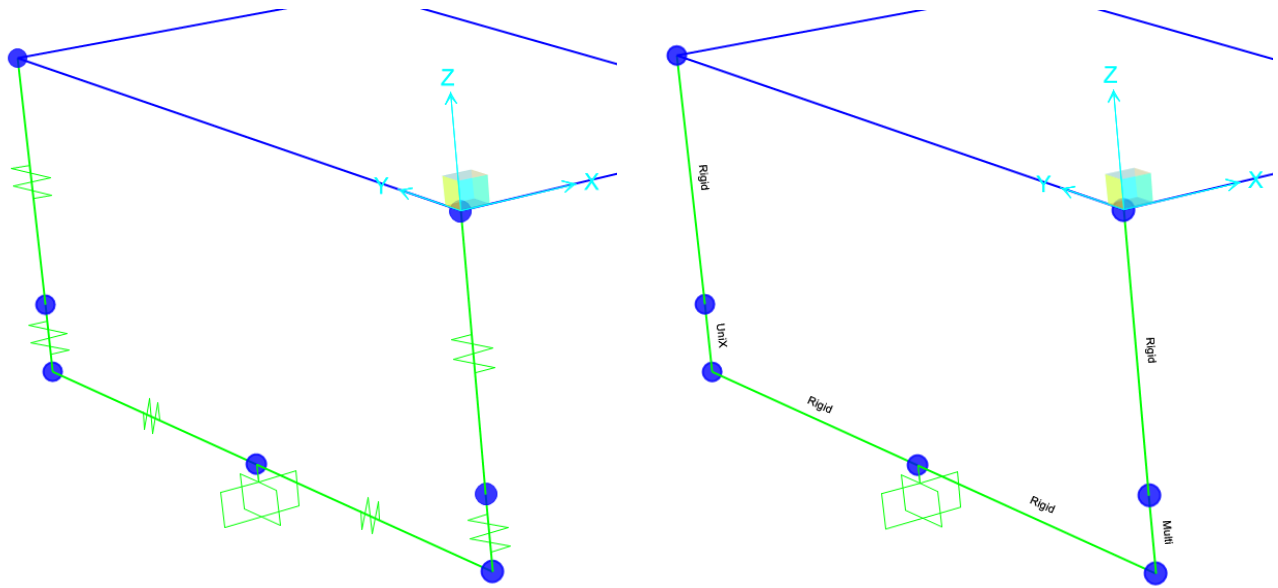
Modellazione connessioni tra travi e appoggi su spalla "SP1" lato Rotonda 1
